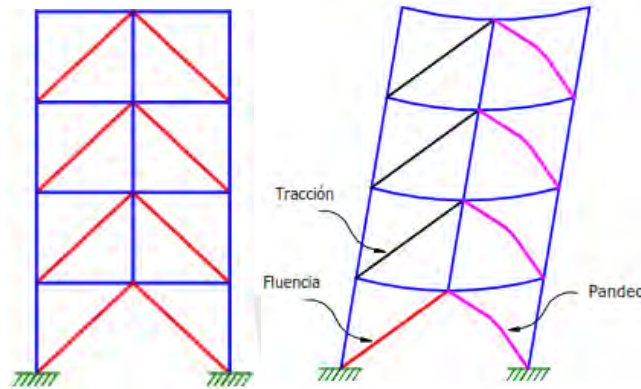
Mecanismo de colapso para pórticos con columna zipper
